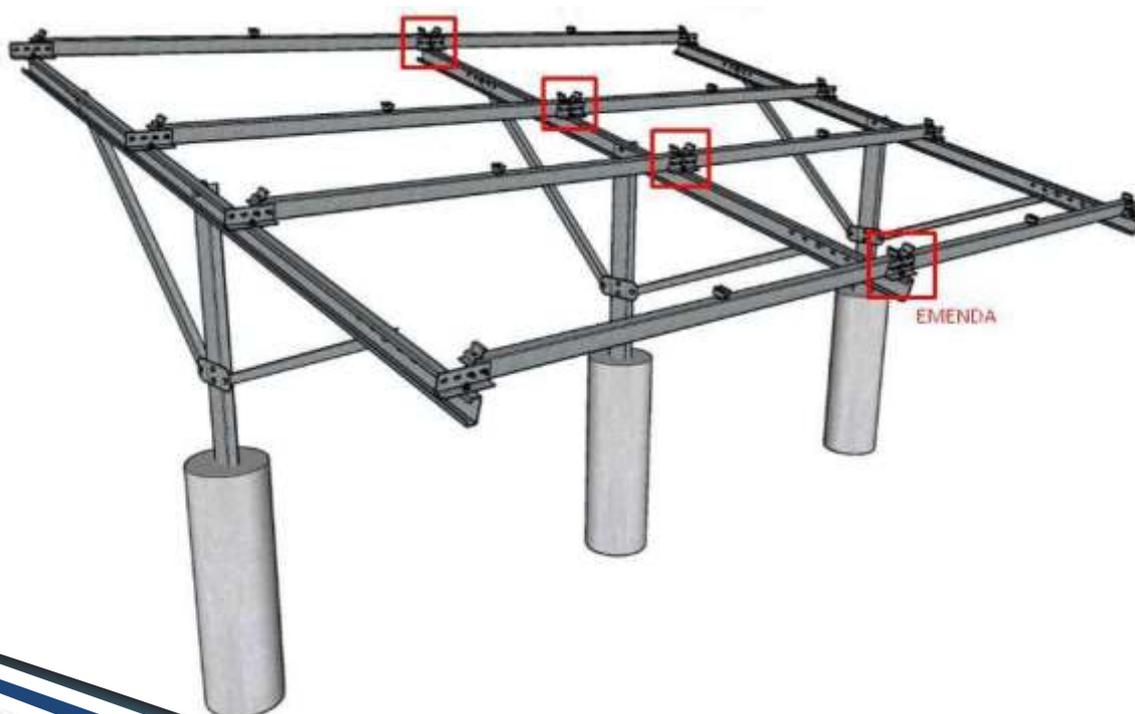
IMAGENS DA ESTRUTURA PARA 4 PLACAS
